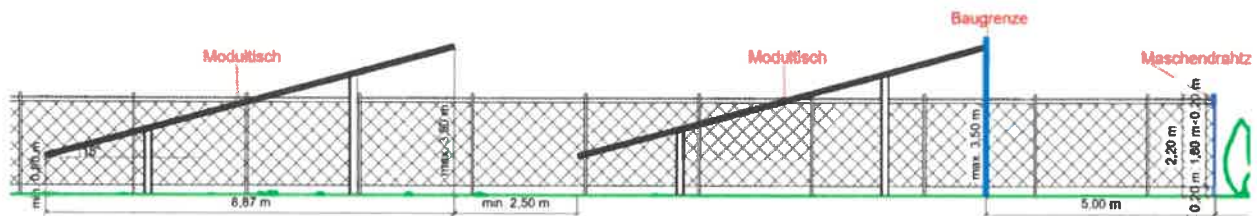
Skizze der Modulkonstruktion (Quelle: Planungsunterlagen)
